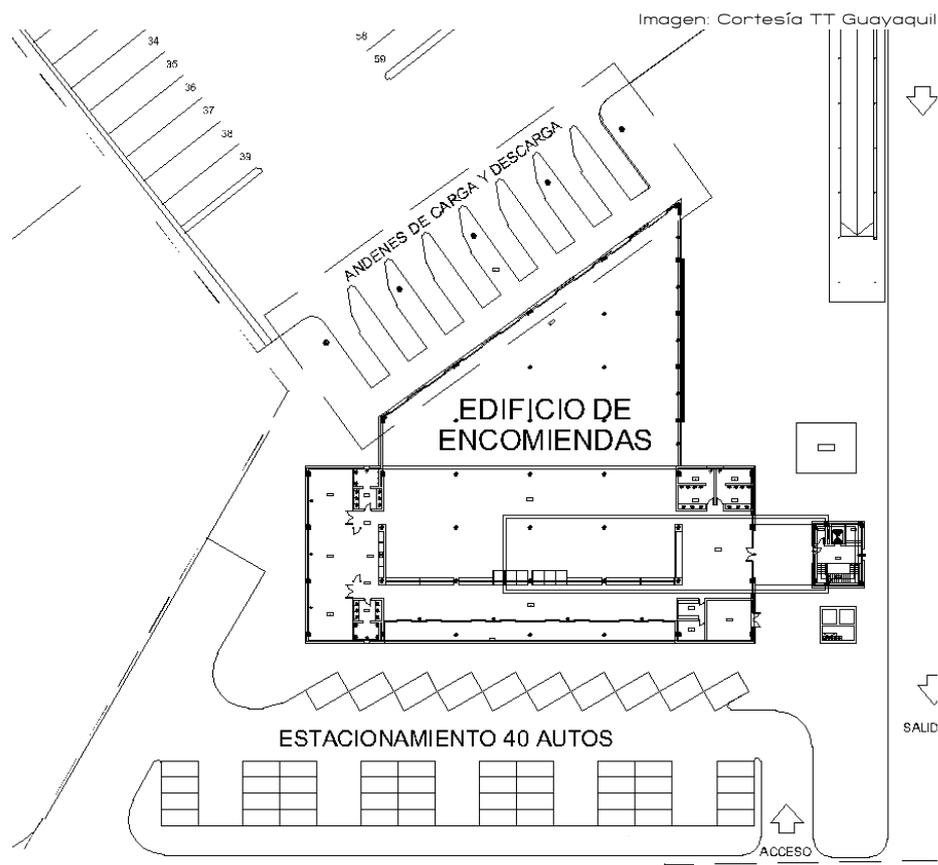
Planta arquitectónica del edificio de encomiendas
